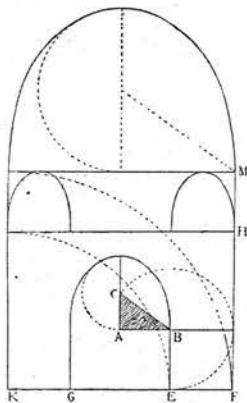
Coupe transversale de la salle B, pl. III (Épure de construction).
